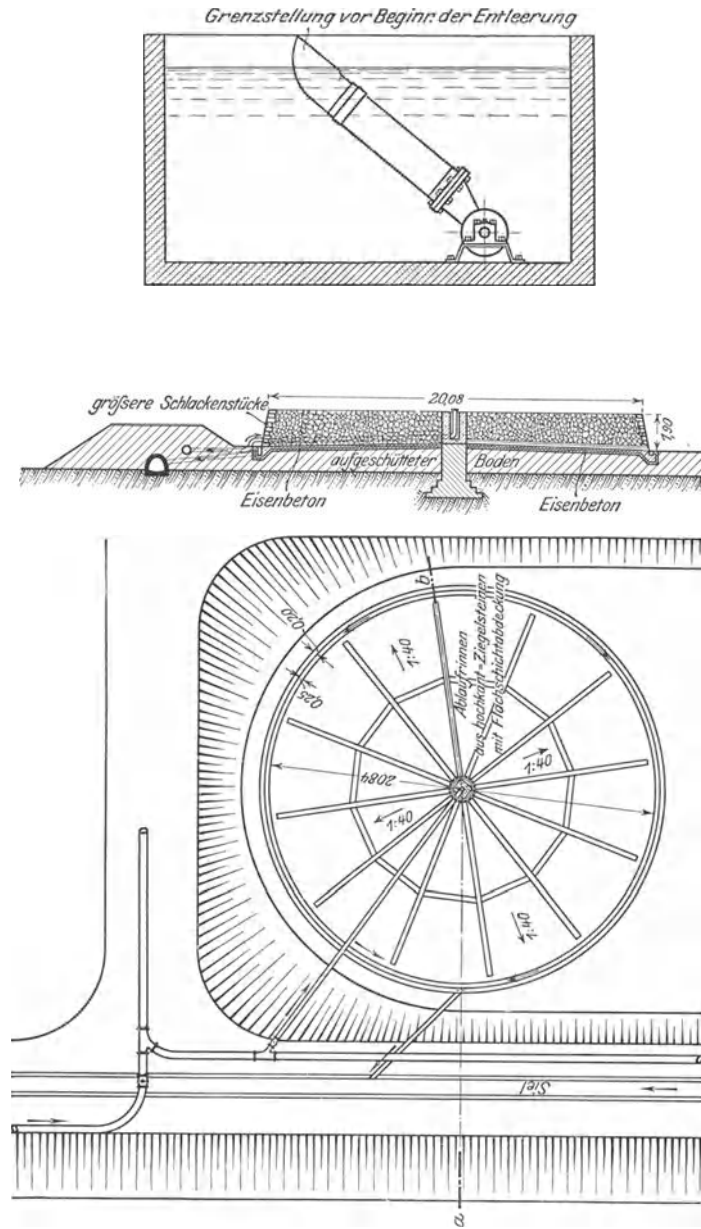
Grundriß und Schnitt eines Tropfkörpers
